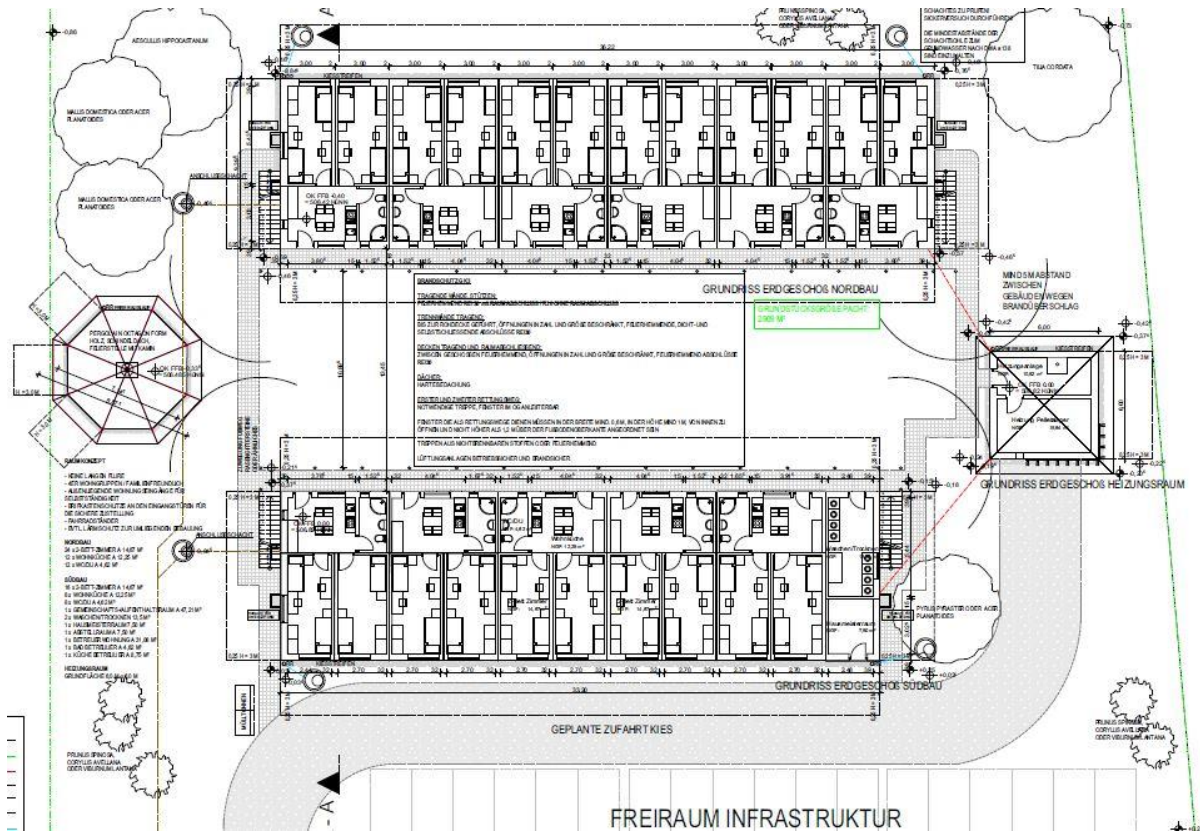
Grundriss EG Asylunterkunft Halving (Quelle: Aicher Projekt GmbH & Co.KG)
